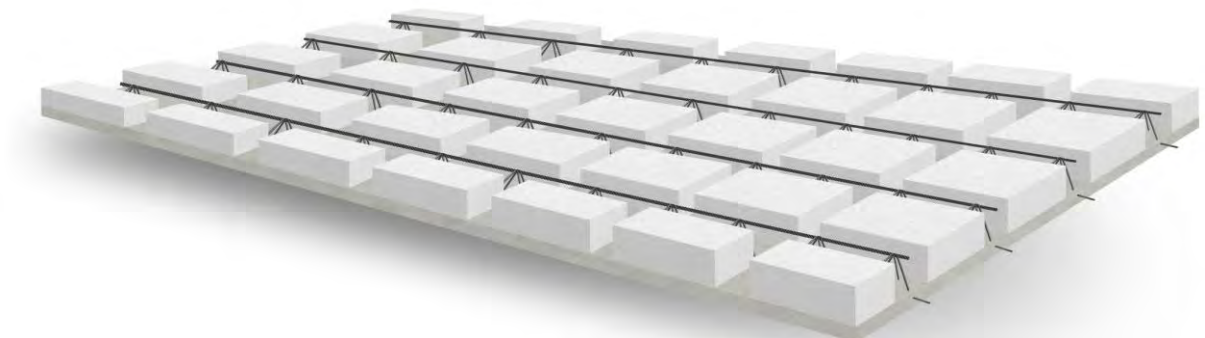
Vista de planta del diseño de prelosas ligeras – aligerado compuesto
